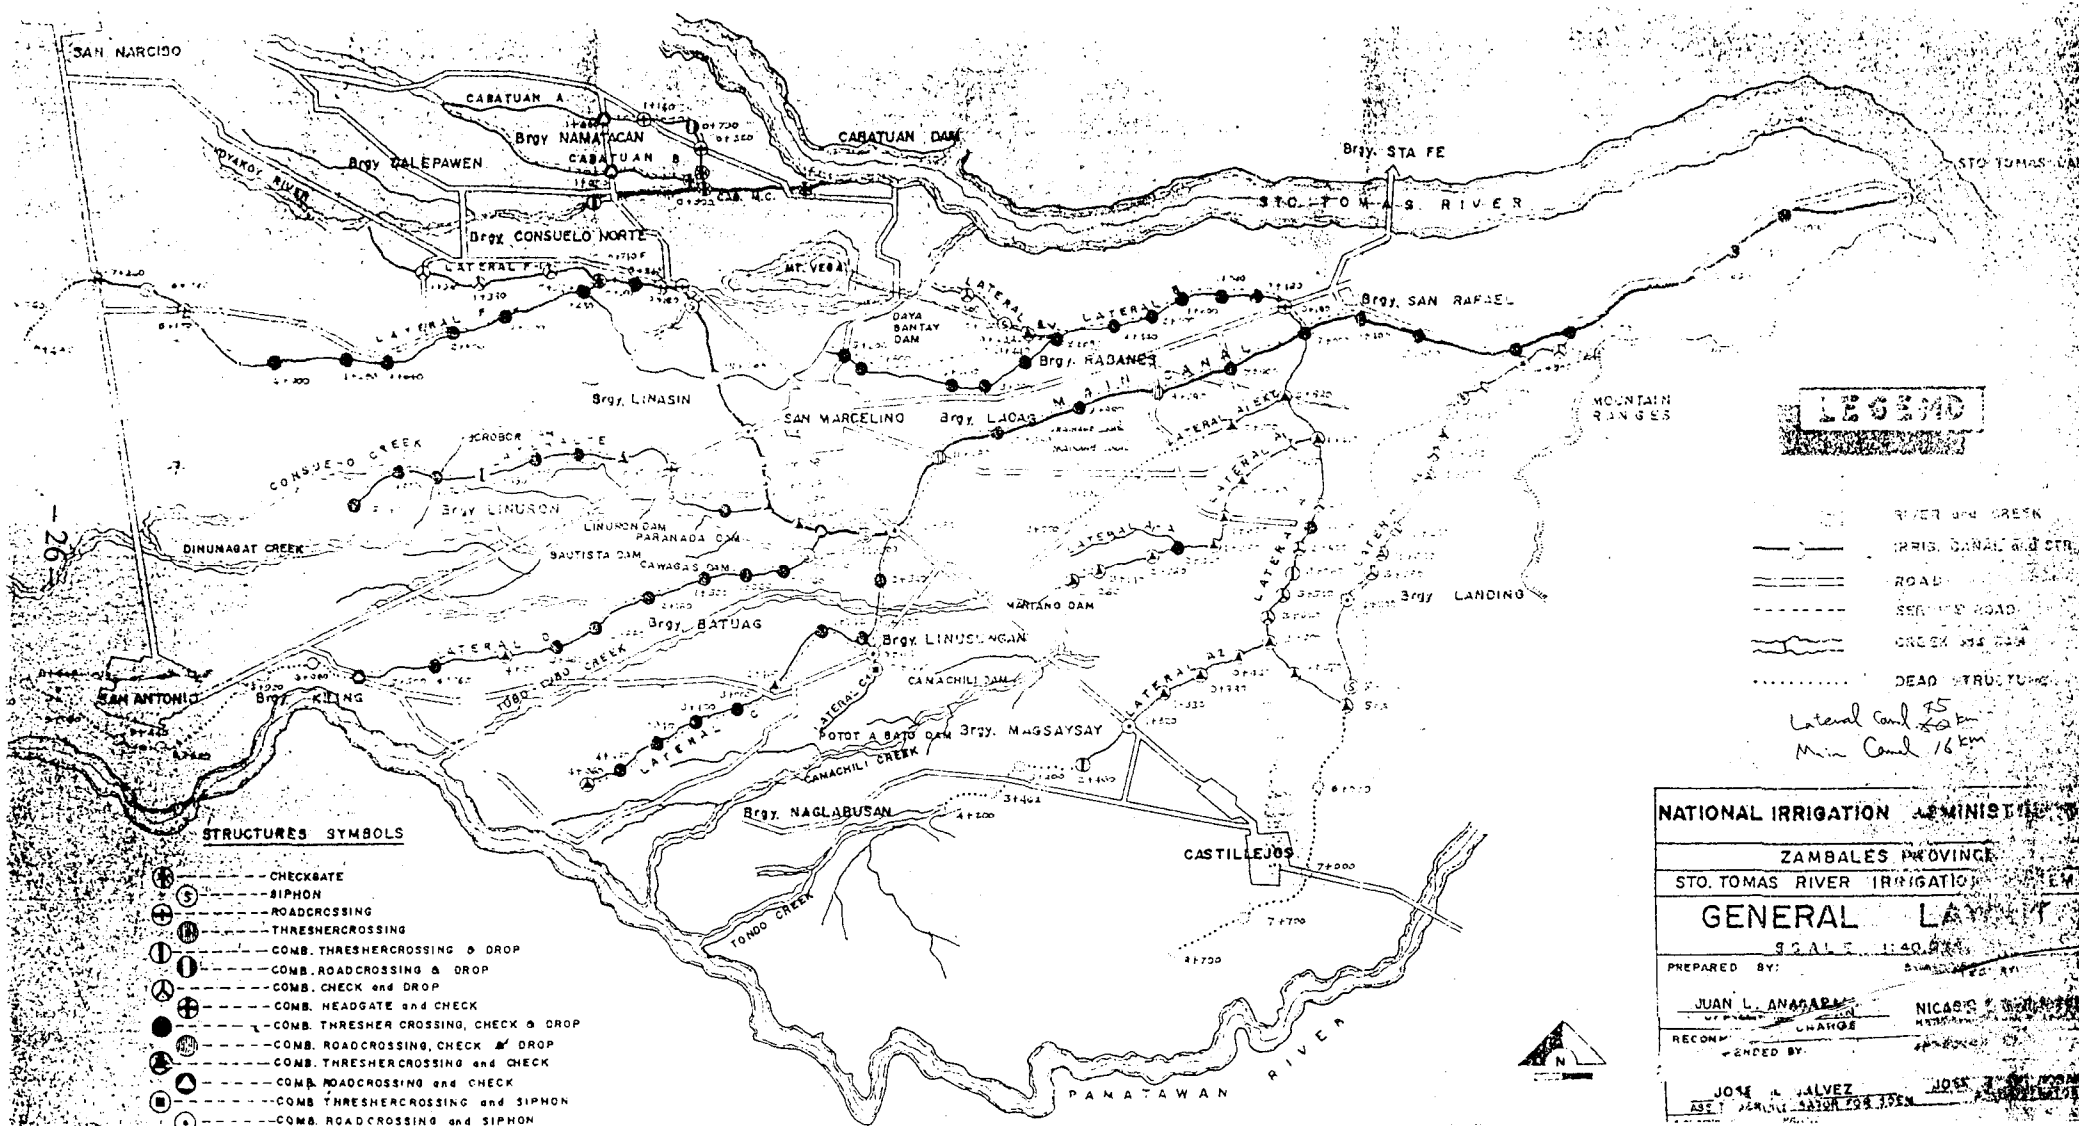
1 サント・トーマス川灌漑システム平面図 (ピナツボ噴火以前)
